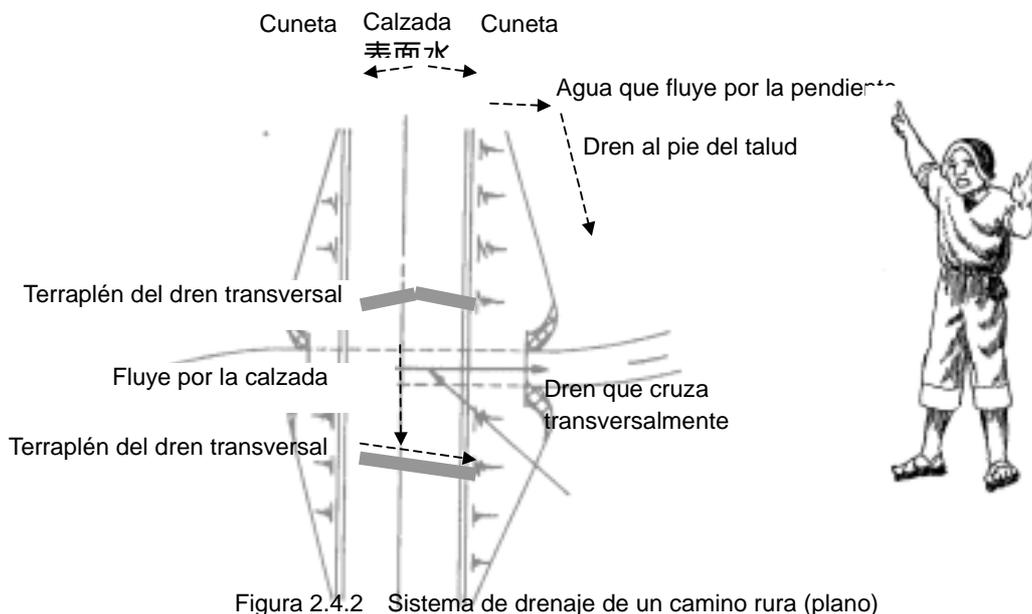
Sistema de drenaje de un camino rural (plano)
